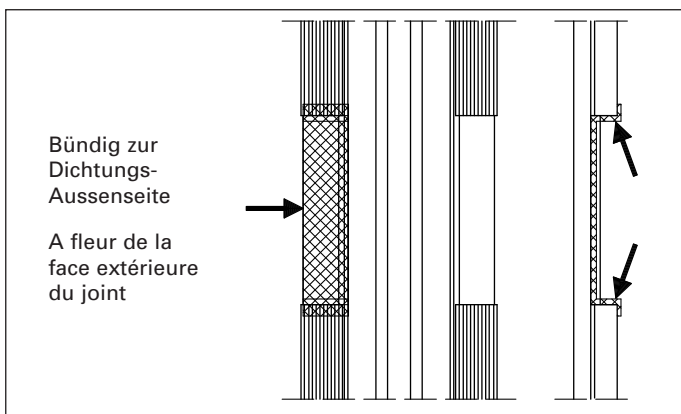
Butyl-Dichtstück U-förmig eindrücken
